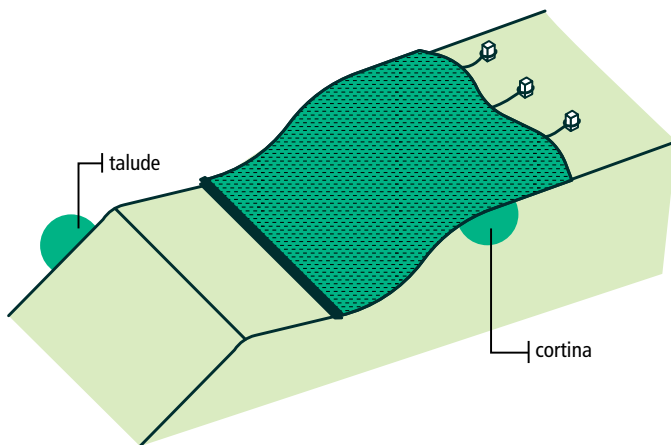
ESCAVAÇÃO PROTEGIDA COM ESTRUTURAS DENOMINADAS CORTINAS
